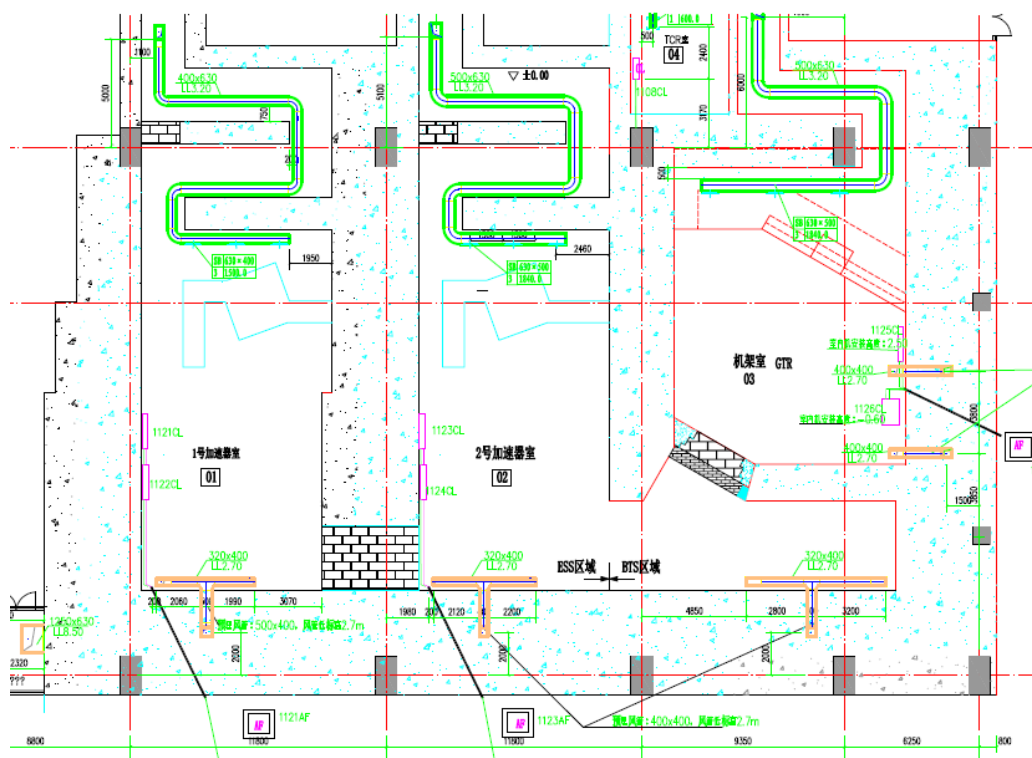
通风管线穿越屏蔽墙体示意图（水平布置图）
